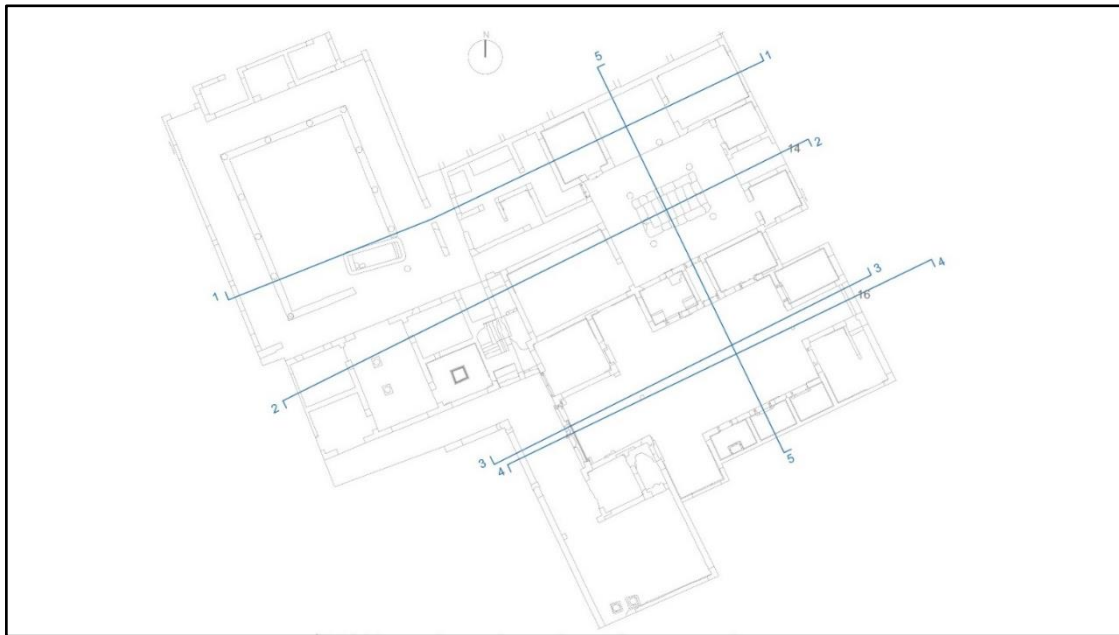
Posizione delle sezioni-prospetto della Casa dei Mosaici Geometrici
